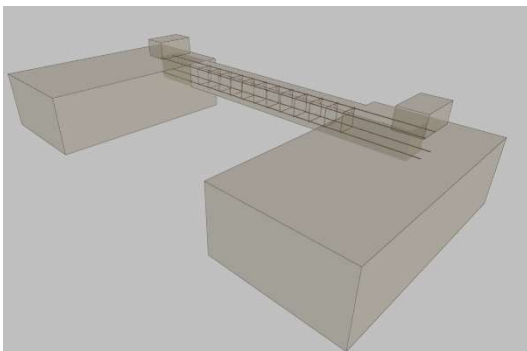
Viga de atado. (Fuente CYPE 3D).
